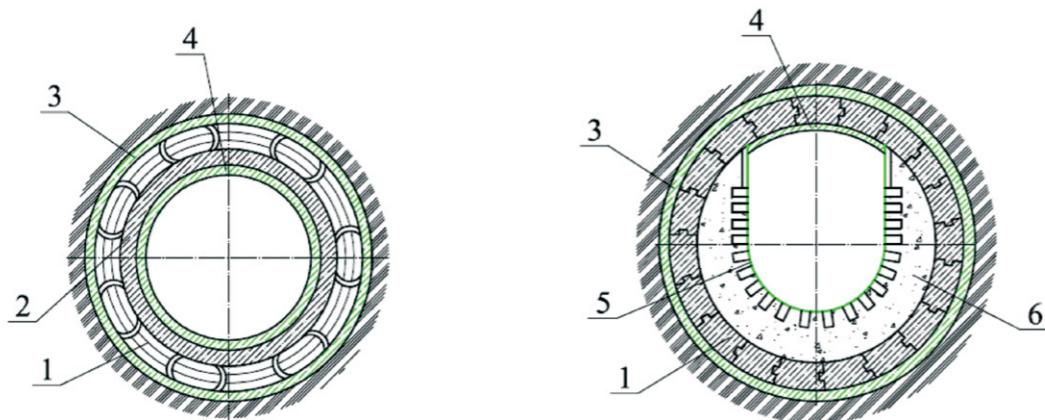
Коллекторы, выполняемые при закрытом способе строительства
